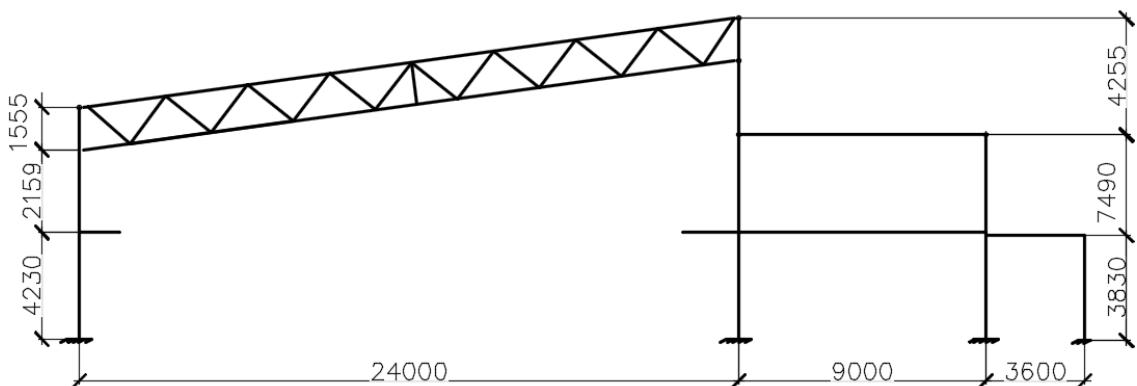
Расчетная схема поперечной рамы
